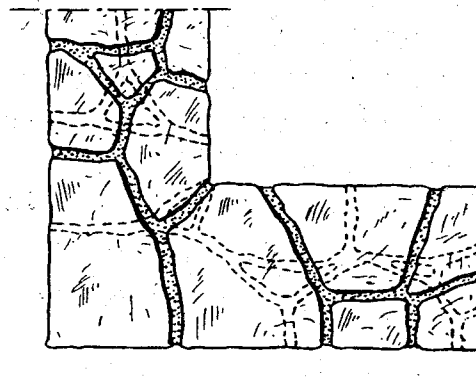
Ángulo de un muro de mampostería aparejado por hiladas horizontales (planta).
